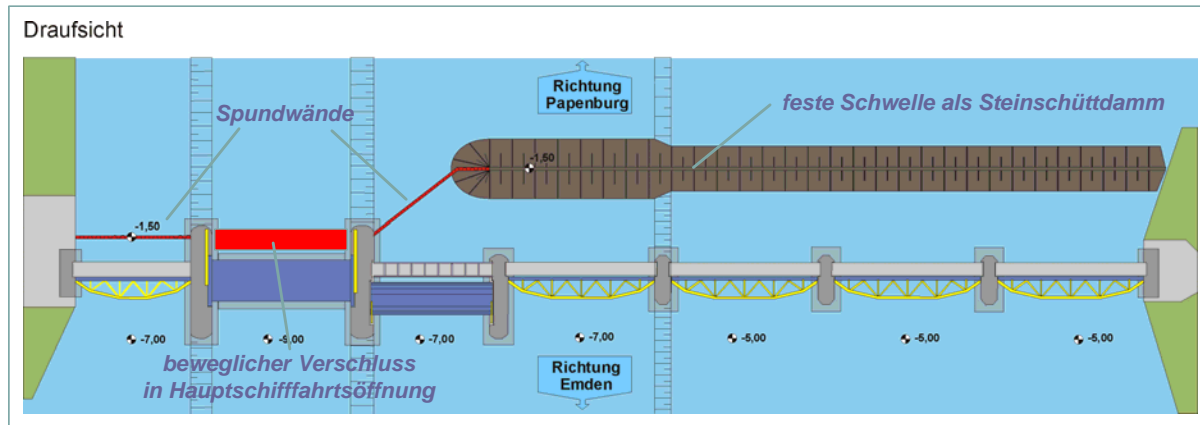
Grundriss des Sperrwerks mit Anordnung einer festen Schwellenlinie und beweglichem Verschluss in der Hauptschiffahrtsöffnung
